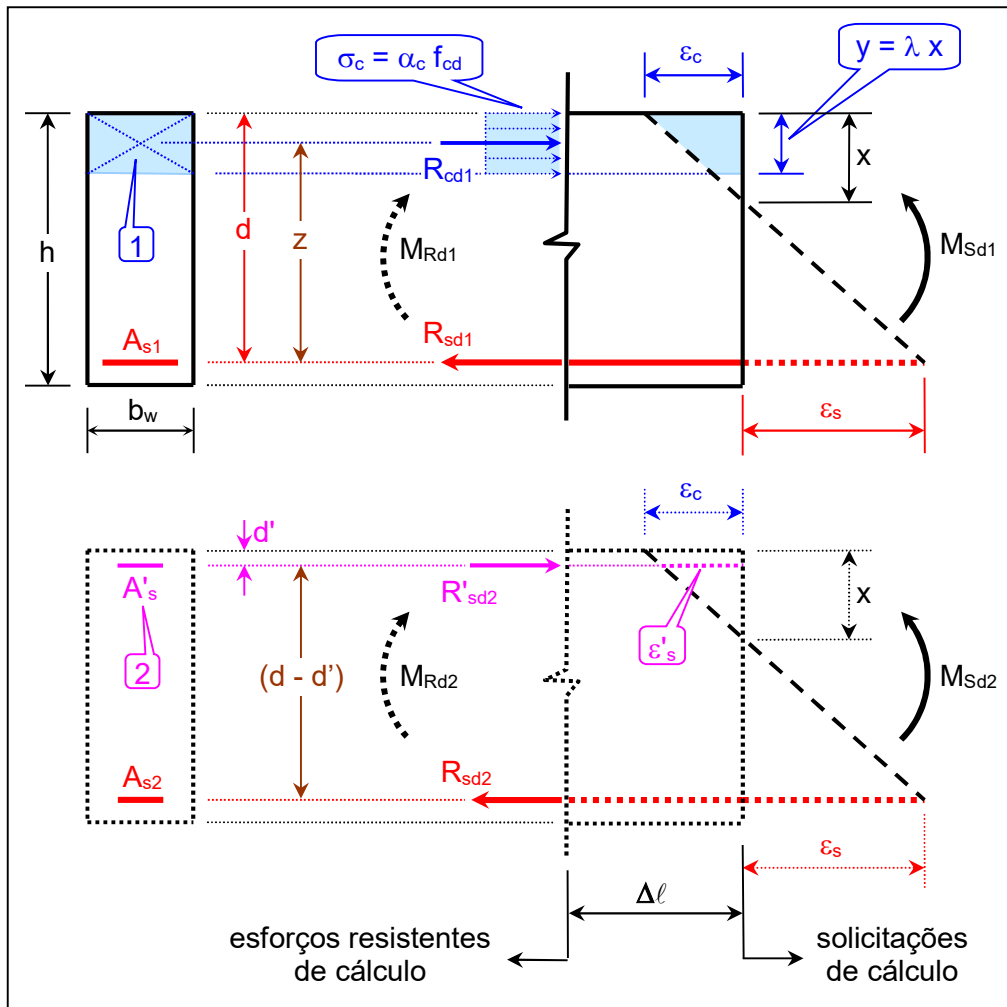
Vigas de seção retangular com armadura de compressão
